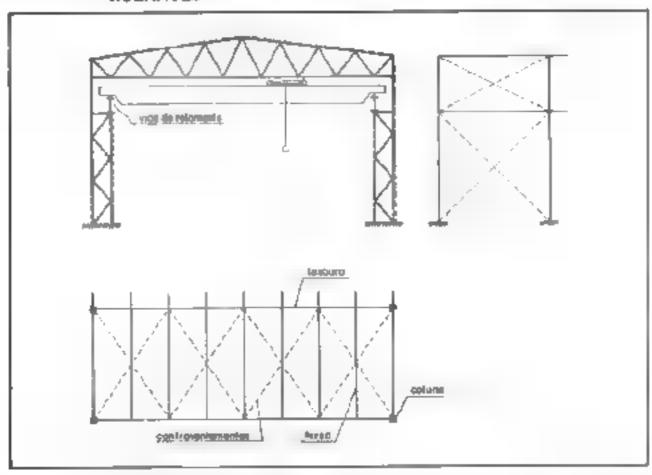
CONTRAVENTAMENTO HORIZONTAL DE VIGA DE ROLAMENTO
